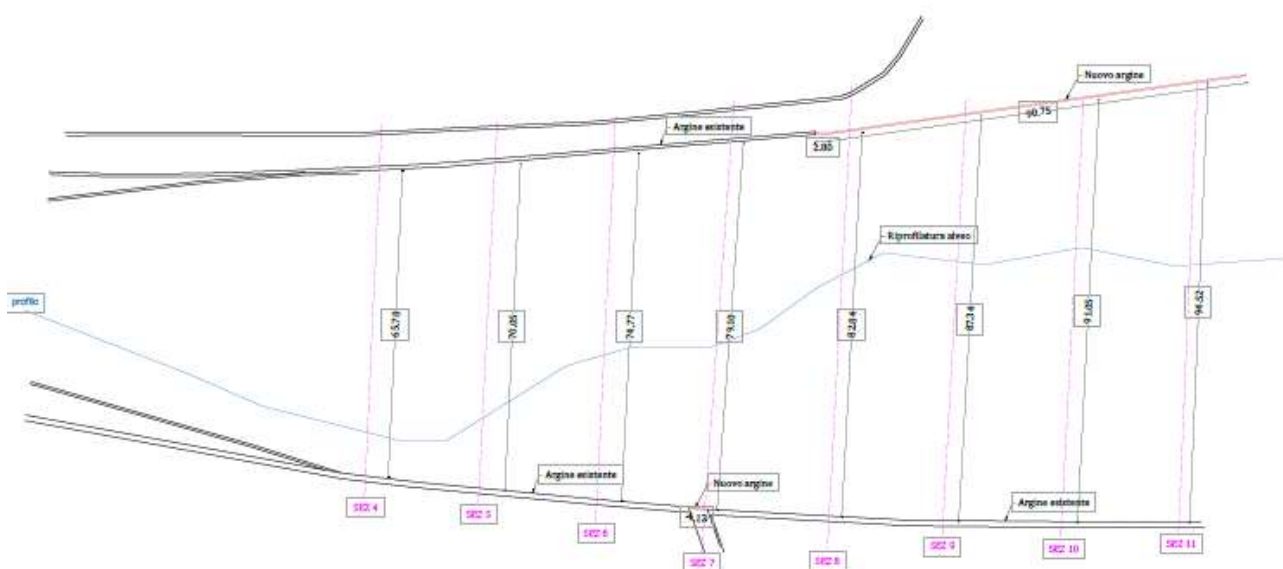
Planimetria ubicazione interventi. 2° Intervento
